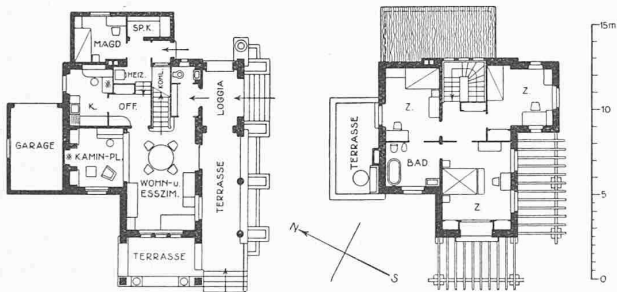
Grundrisse des Hauses F. am Cap d'Antibes. — 1:400.
